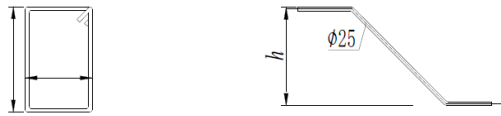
钢箍和弯起钢筋的尺寸
